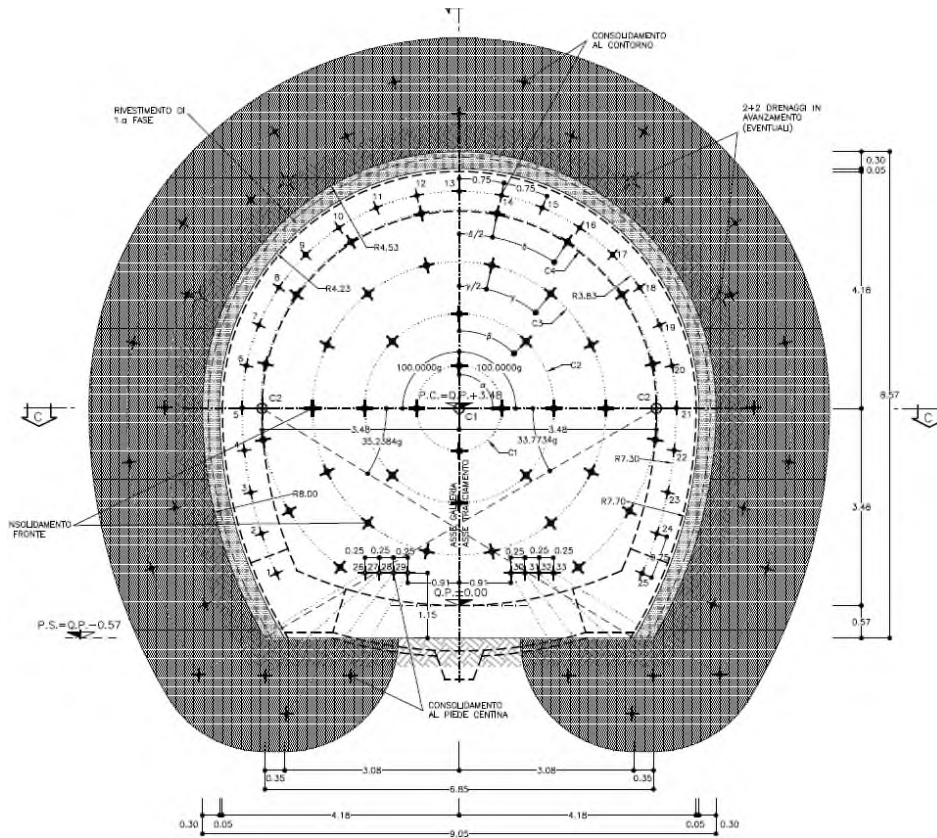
Sezione Tipo C2 – Scavi e consolidamenti - Sezione
